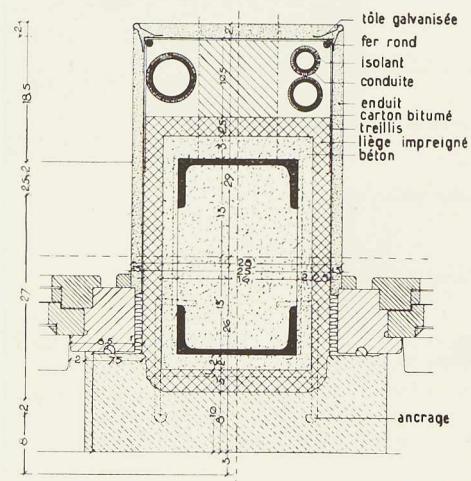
Schéma montrant l'enrobage des poteaux en façade.
